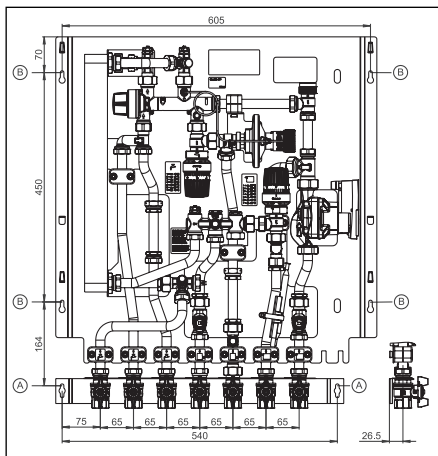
Schema di collegamento barra di fissaggio valvole a sfere 1321180
